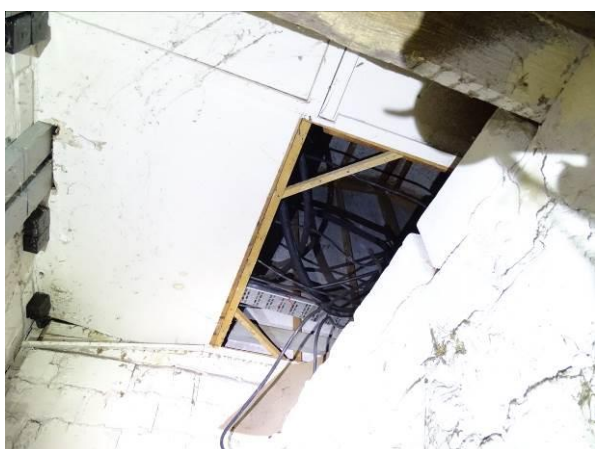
Dachkonstruktion der Klubbaracke, ungedämmt
